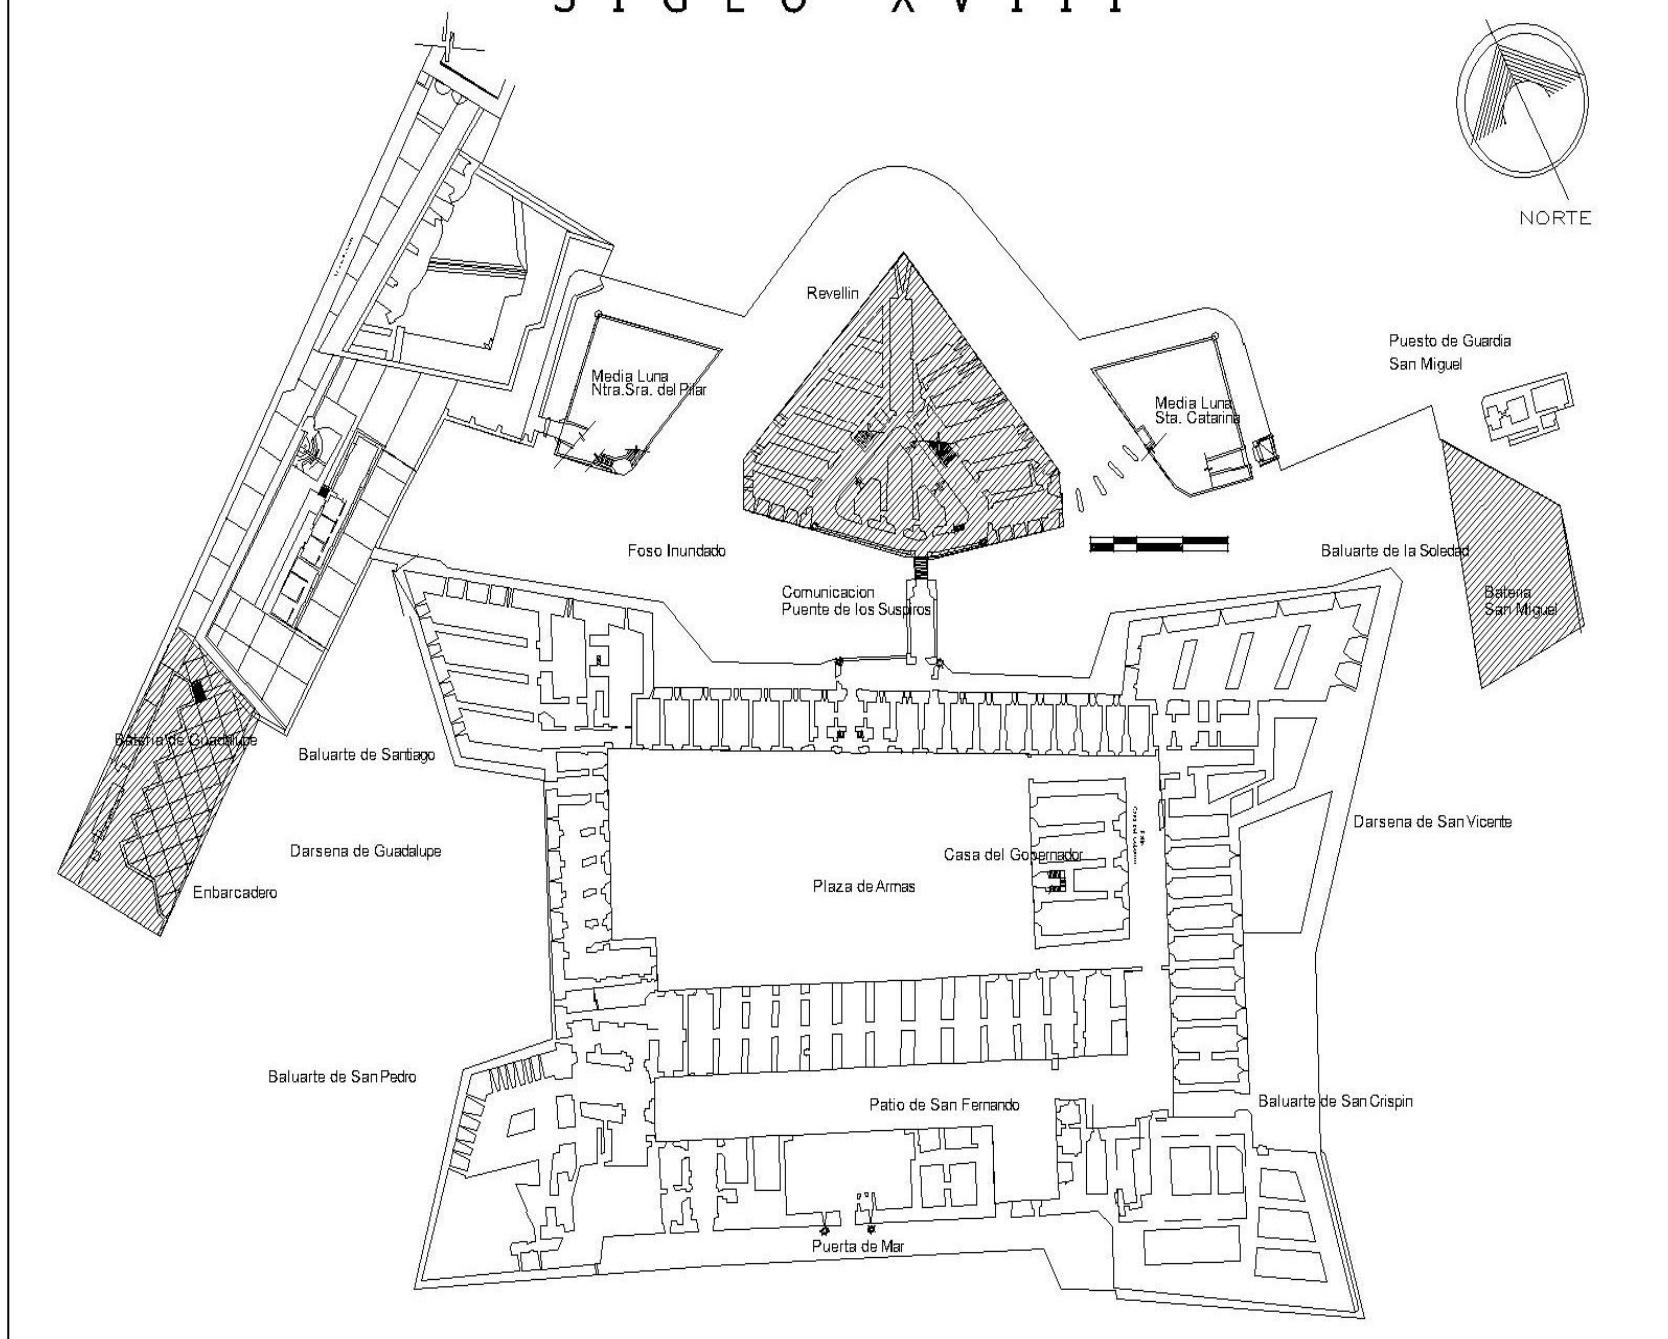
Proceso constructivo de 1741 de la batería de Guadalupe y san miguel por Félix Prosperí. En 1762 construcción de la batería de San José, posteriormente sería como el revellín. Edito plano: Arq. Angelina del Carmen González Díaz. 2015
